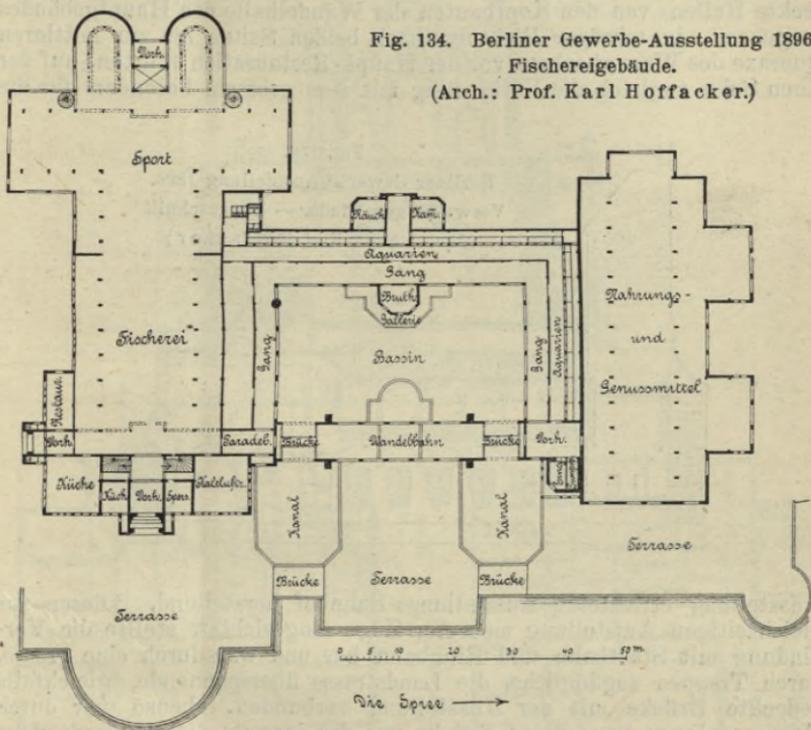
Berliner Gewerbe-Ausstellung 1896.
